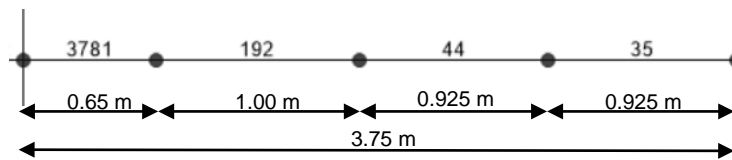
Identificação da Viga V1.4 da Travessa do Pórtico B
